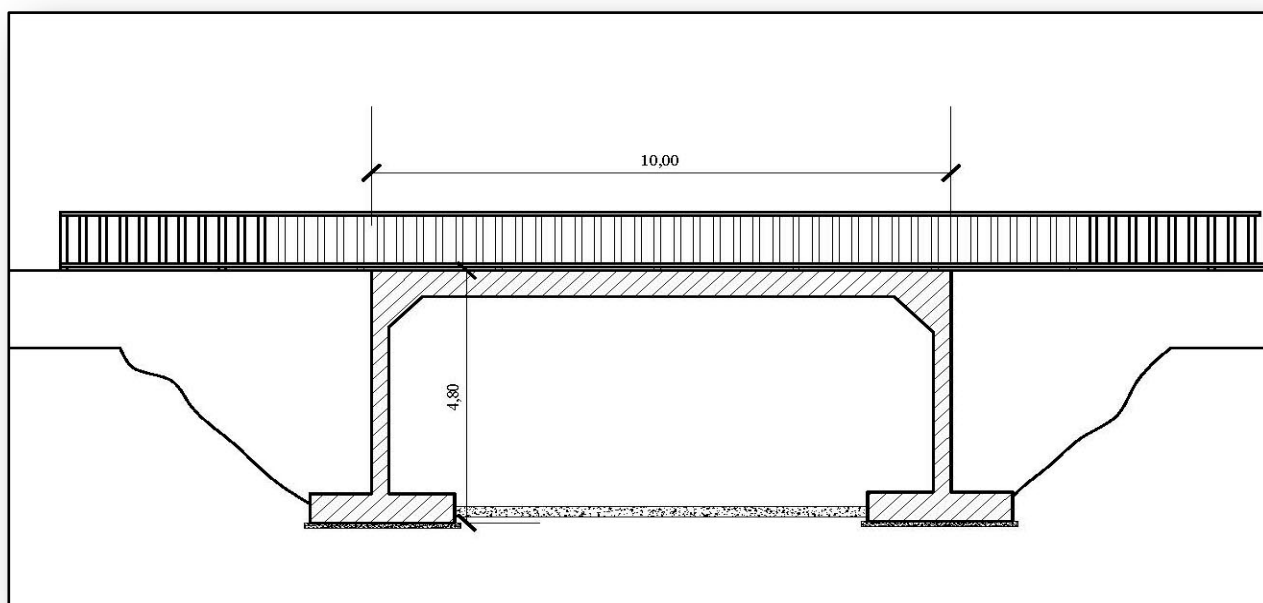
Coupe en élévation de l'ouvrage.
